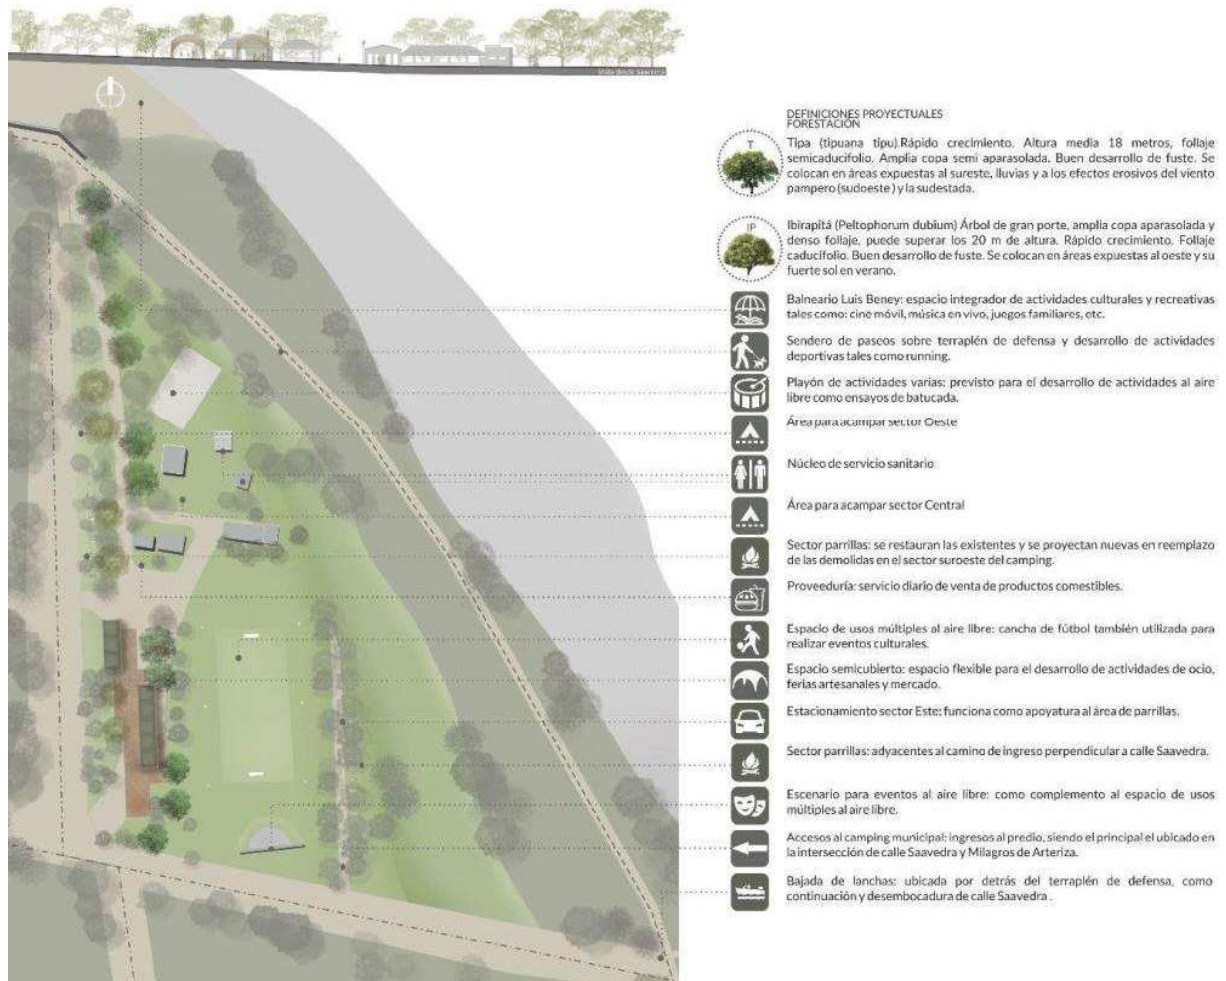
Master plan. Ubicación del proyecto en el sitio. Relevamiento de las preexistencias.
